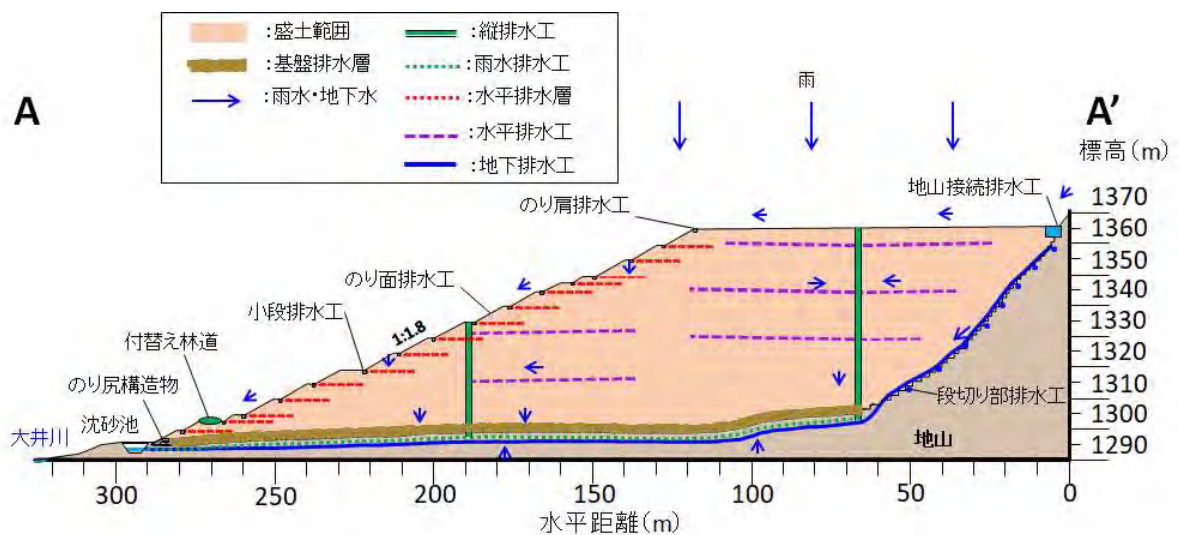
ツバクロ発生土置き場 断面図 (A - A' 断面)
